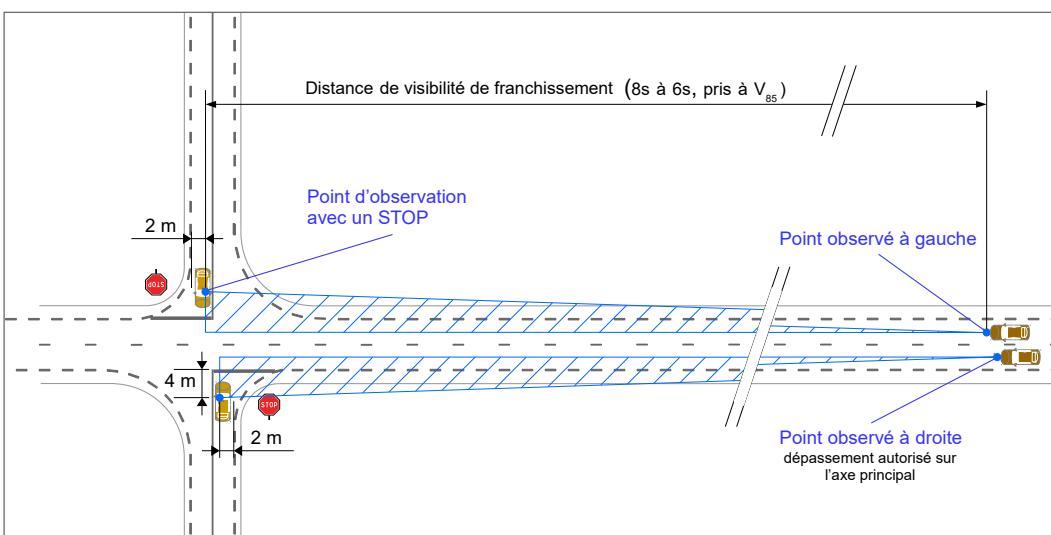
Construction des triangles de visibilité pour les usagers de la route secondaire - Situation d'arrêt (STOP)
